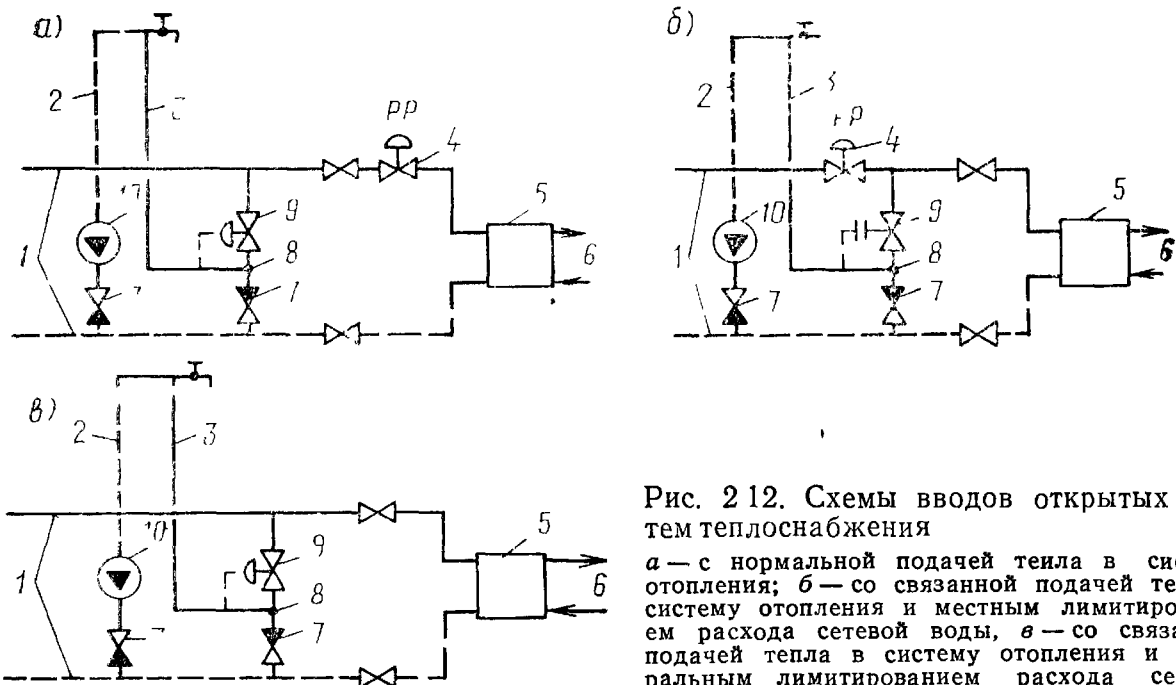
Схемы вводов открытых систем теплоснабжения
